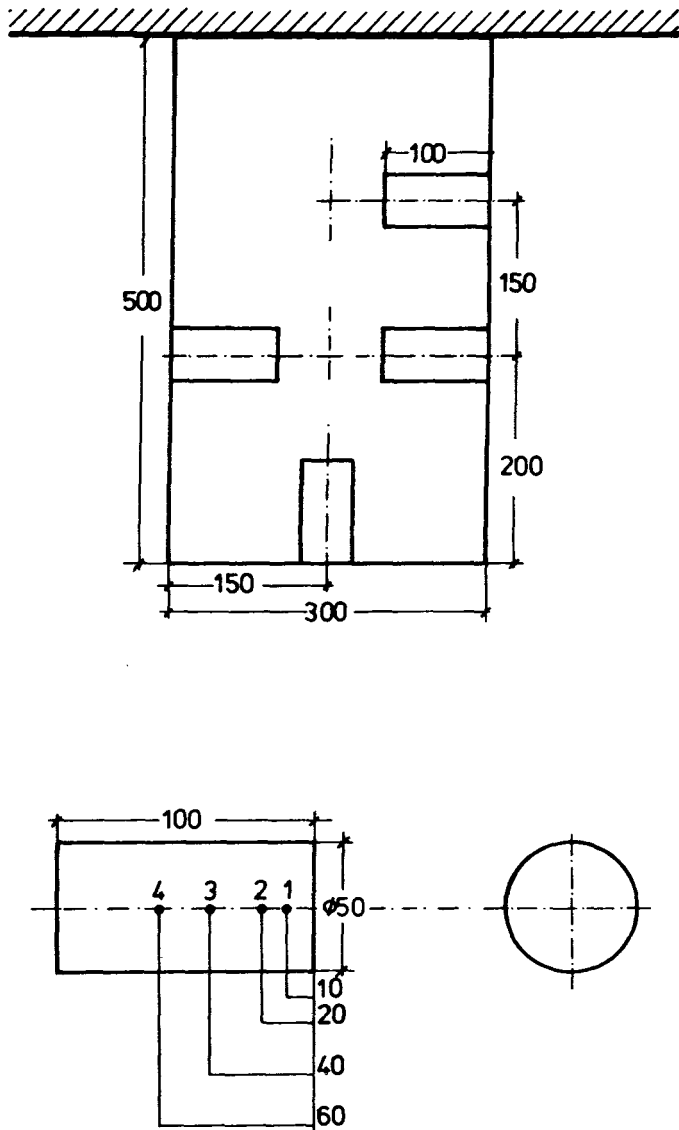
Deckenunterzug mit Meßsteinen (oben) und Gasbetonmeßstein mit Temperaturmeßstellen (unten)
